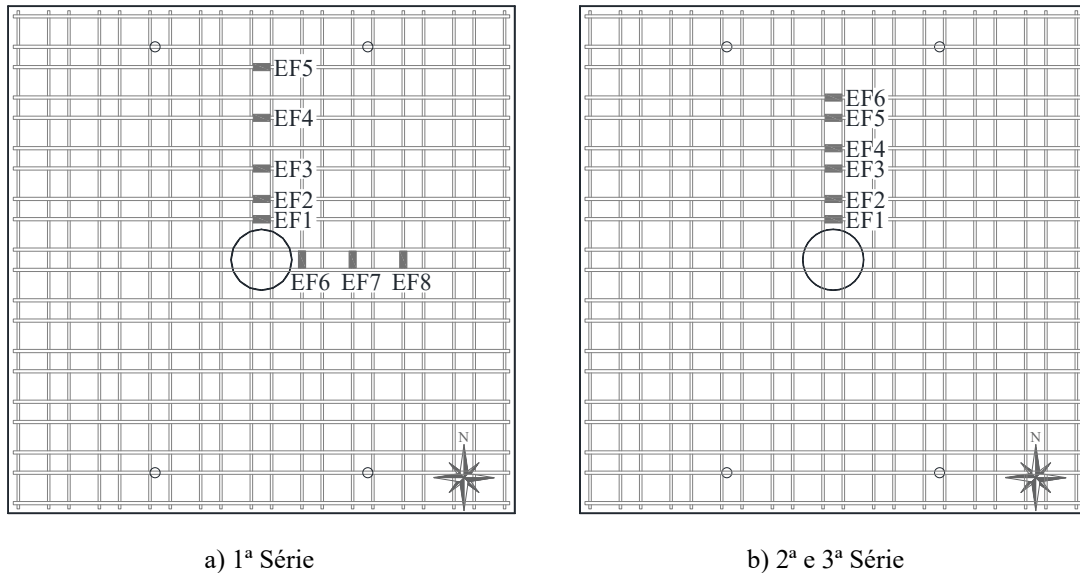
Posição dos extensômetros das armaduras de flexão (EF) – vista em planta
